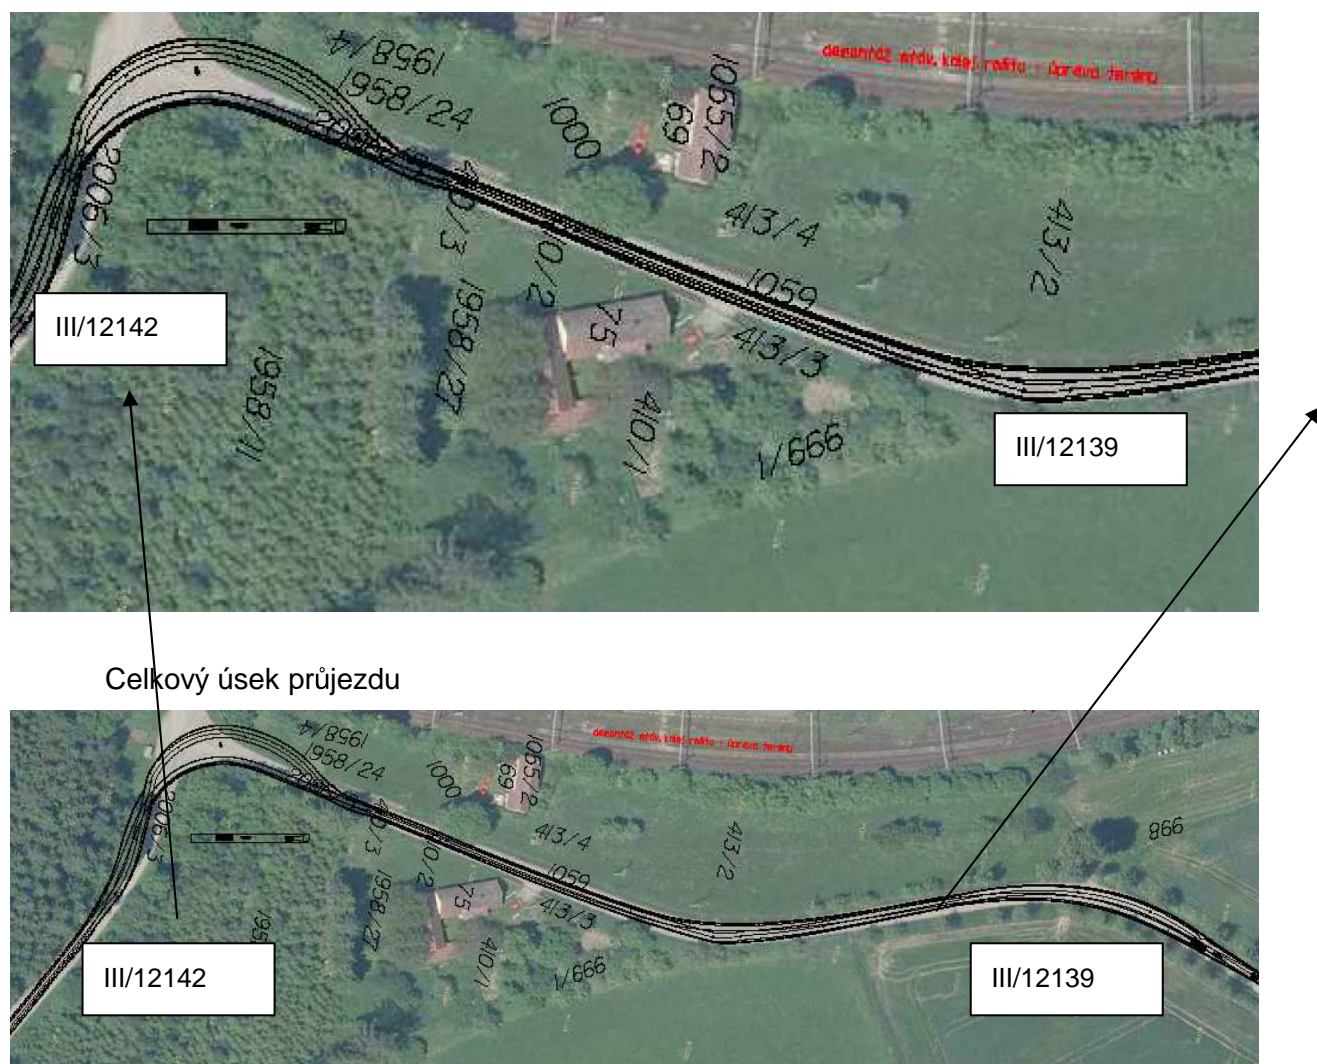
II-III - Silnice I/3 – Miličín- III/12142
